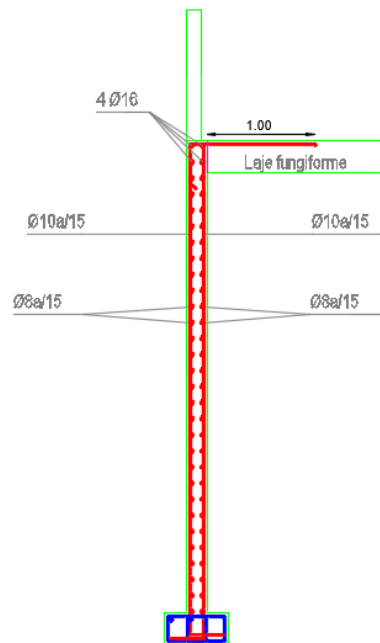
Exemplo do pormenor de construção dos muros (Fonte: Projeto de Estrutura)
